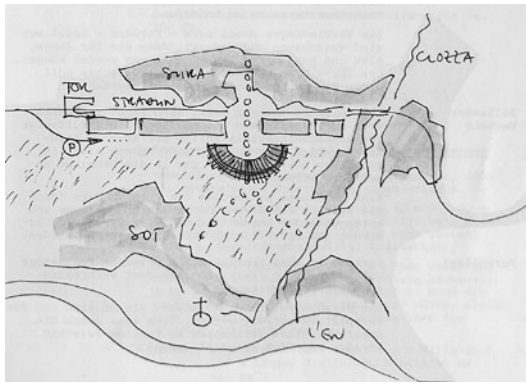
Lageplan des Stradun, Scuol, Robert Obrist, 1980.
